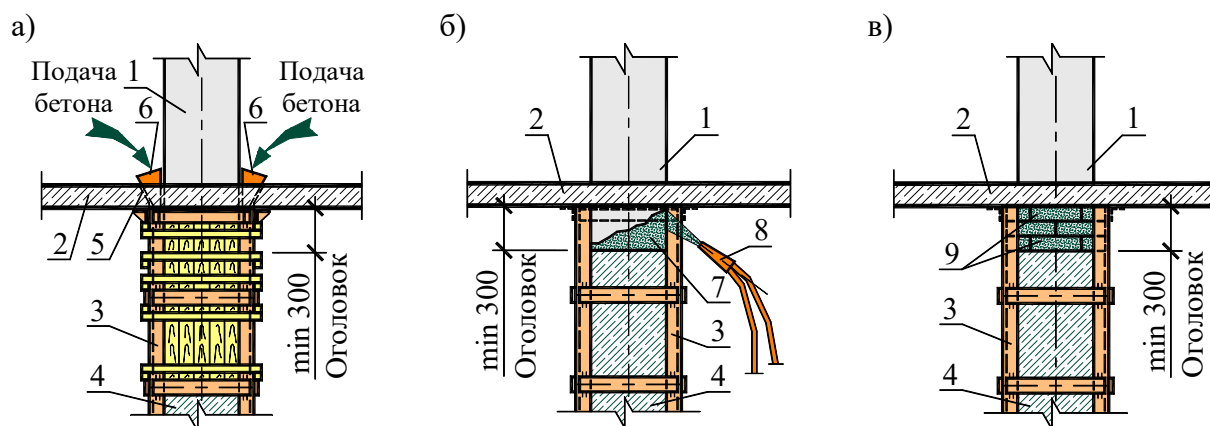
Распределение затрат труда с формированием оголовка усиления при сопряжении усиливаемой колонны с безбалочным плоским перекрытием
